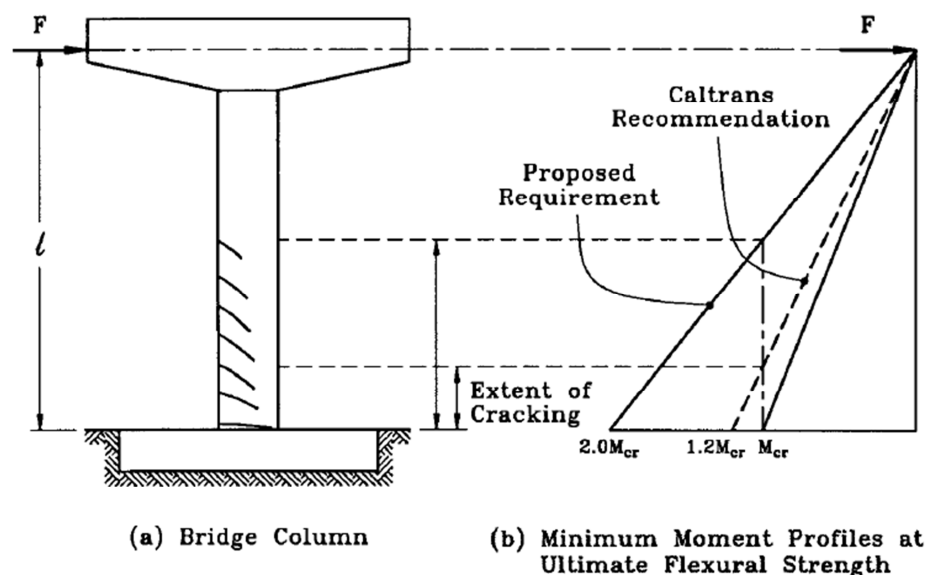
Extensión de las fisuras por flexión para columnas con bajas cuantías de refuerzo longitudinal. (Tomado de Priestley, Seible y Calvi, 1996)
